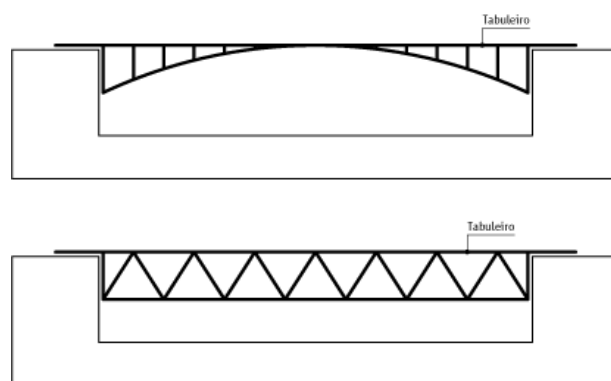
Exemplos – Elevações de pontes rodoviárias horizontais em nível
